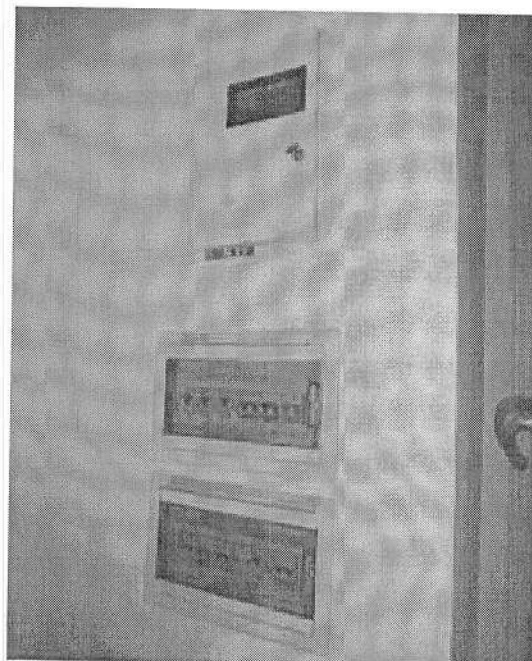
Quadro elettrico ricadente all'interno dell'unità immobiliare non oggetto di pignoramento
